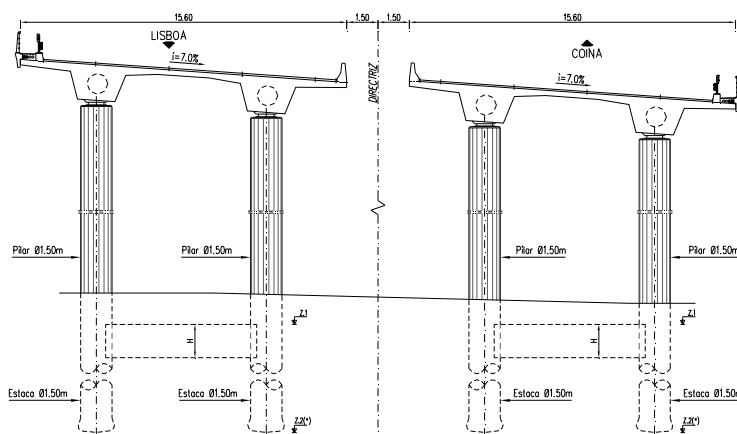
Corte estrutural (Viaduto das Laranjeiras)
